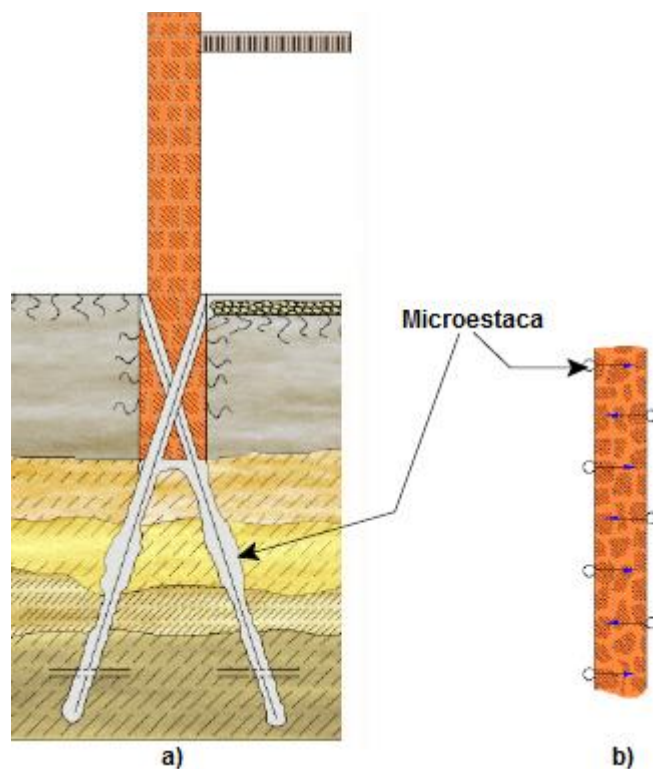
Esquema clássico de reforço de fundações: a) corte; b) planta [4]
